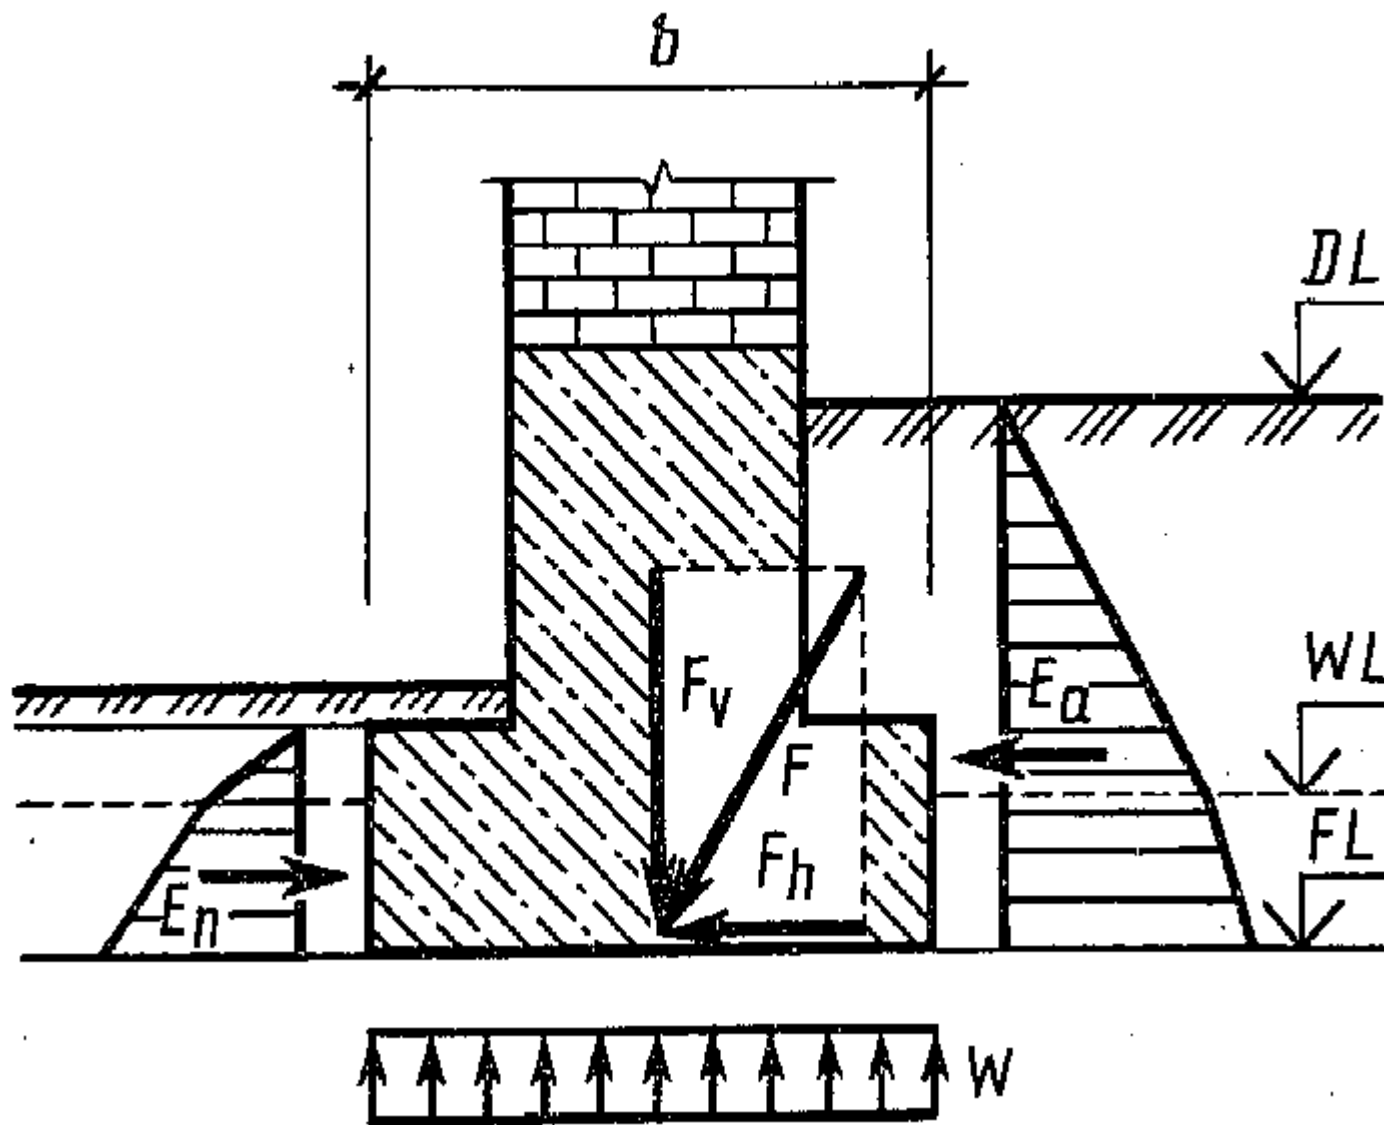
Схема к расчету фундамента на плоский сдвиг
